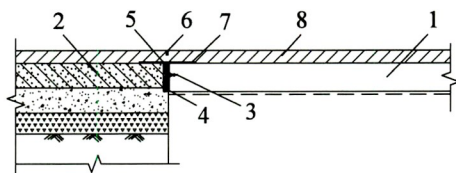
过渡板(或引板)与沥青混凝土路面连接方法
